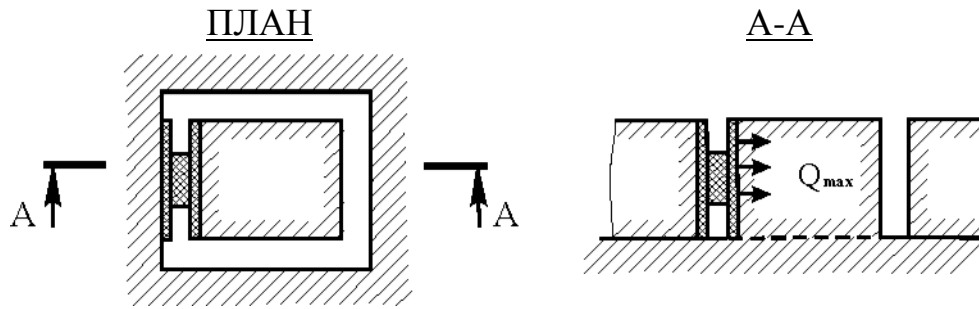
Схема натуральных испытаний горных пород путем плоского среза
